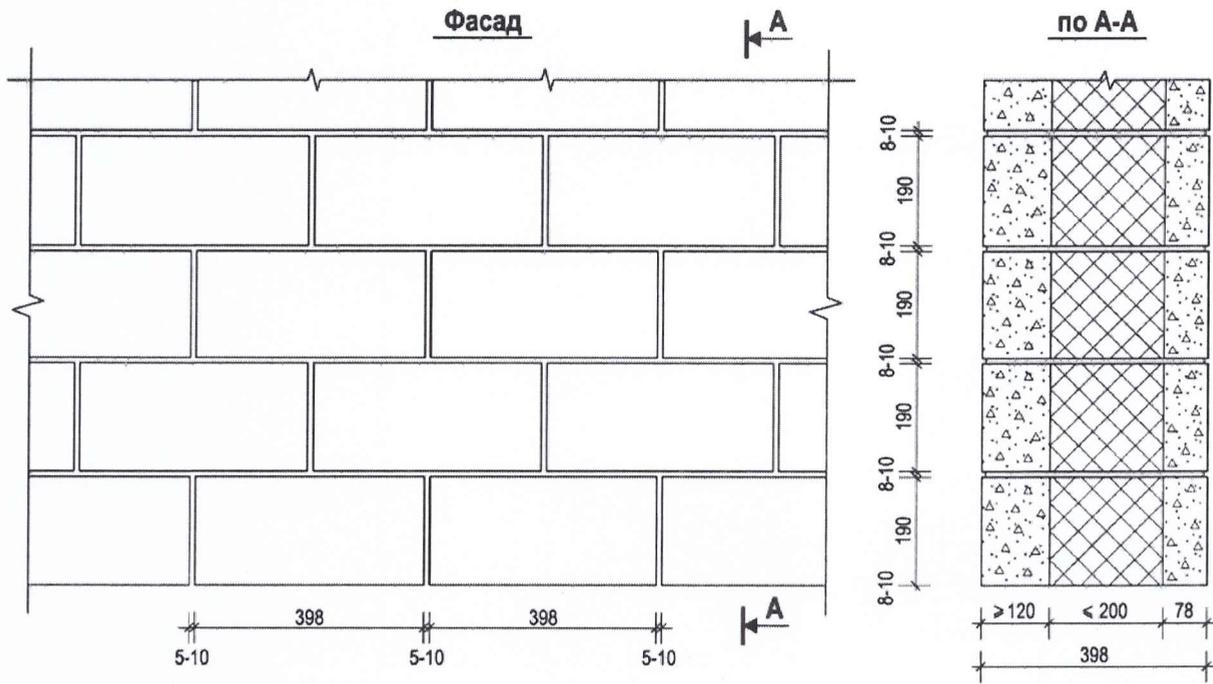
Кладка наружных стен однорядной системы перевязки из многослойных блоков
